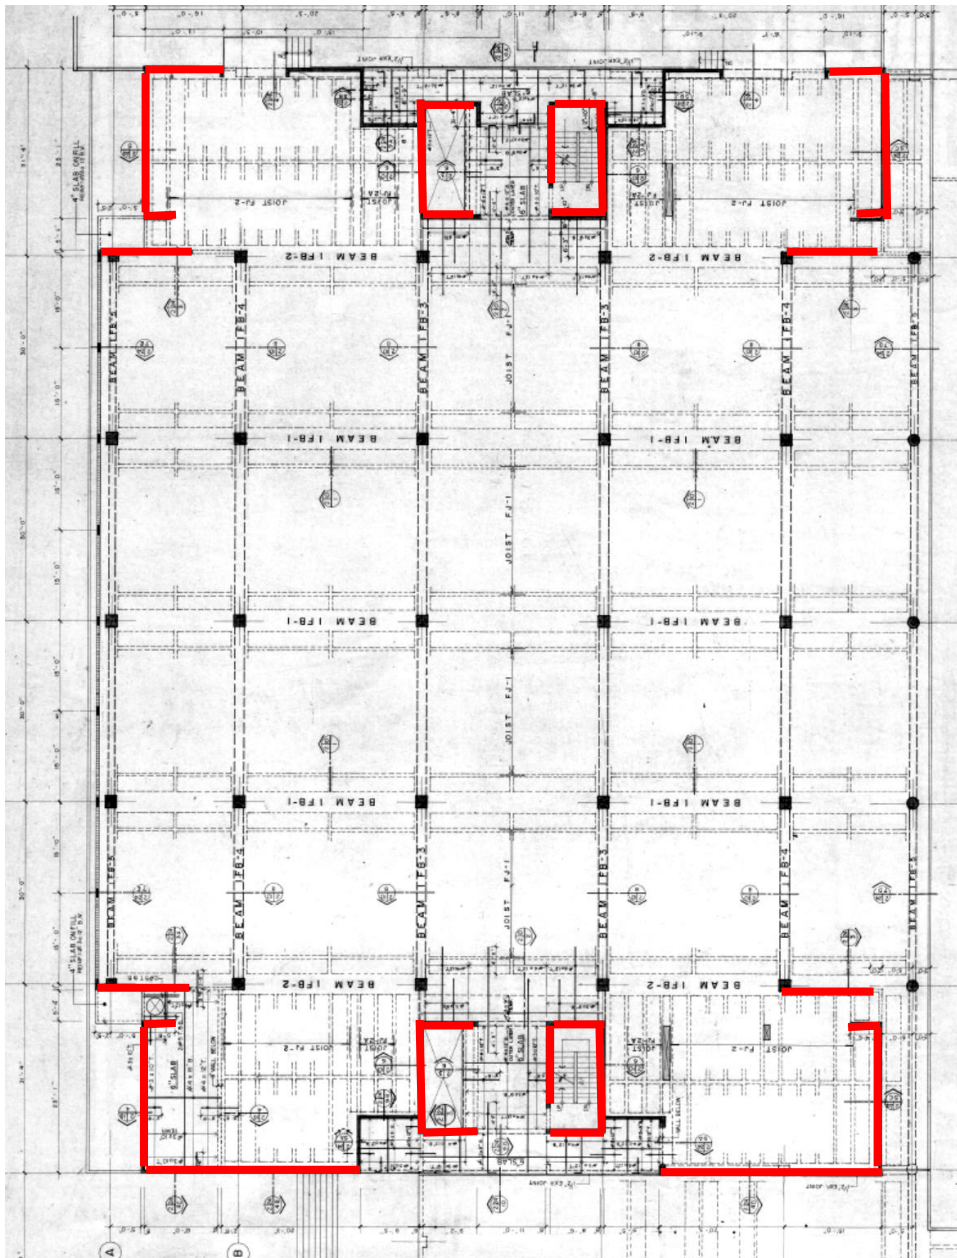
, Planta estructural de primer nivel Edificio Oeste (A).
